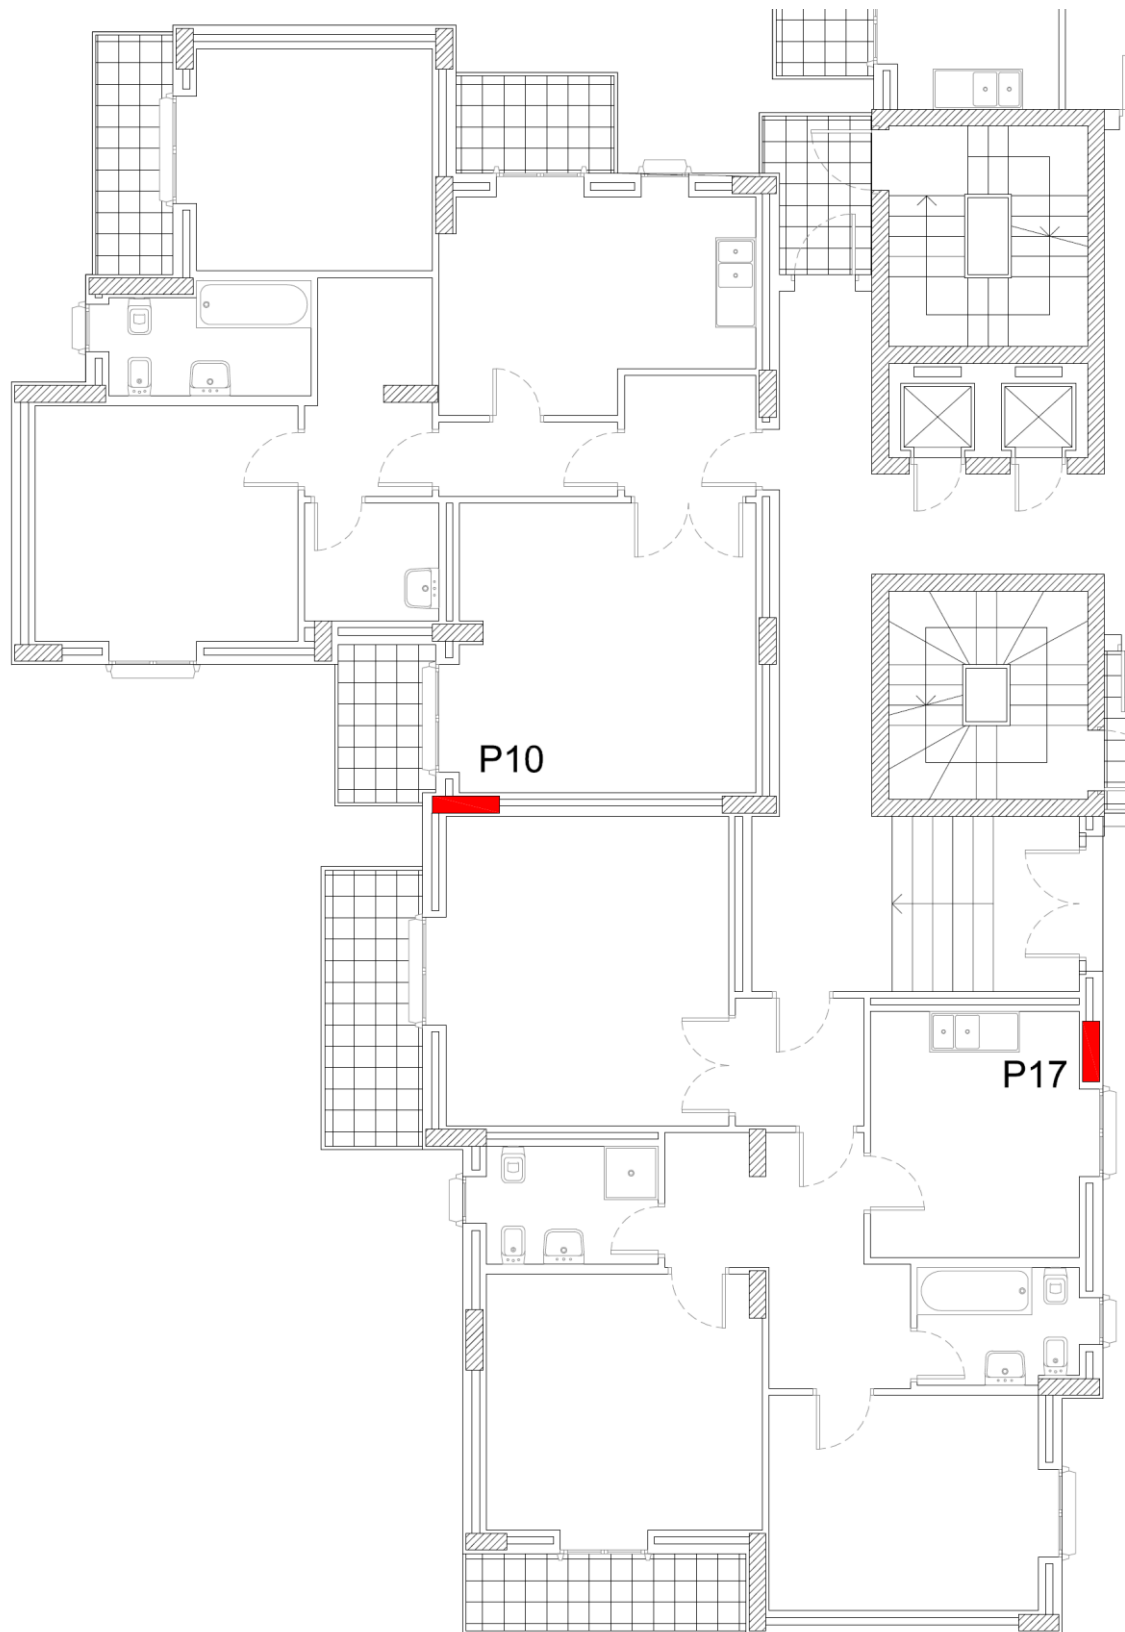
Disposizione in pianta dei pilastri più sollecitati
